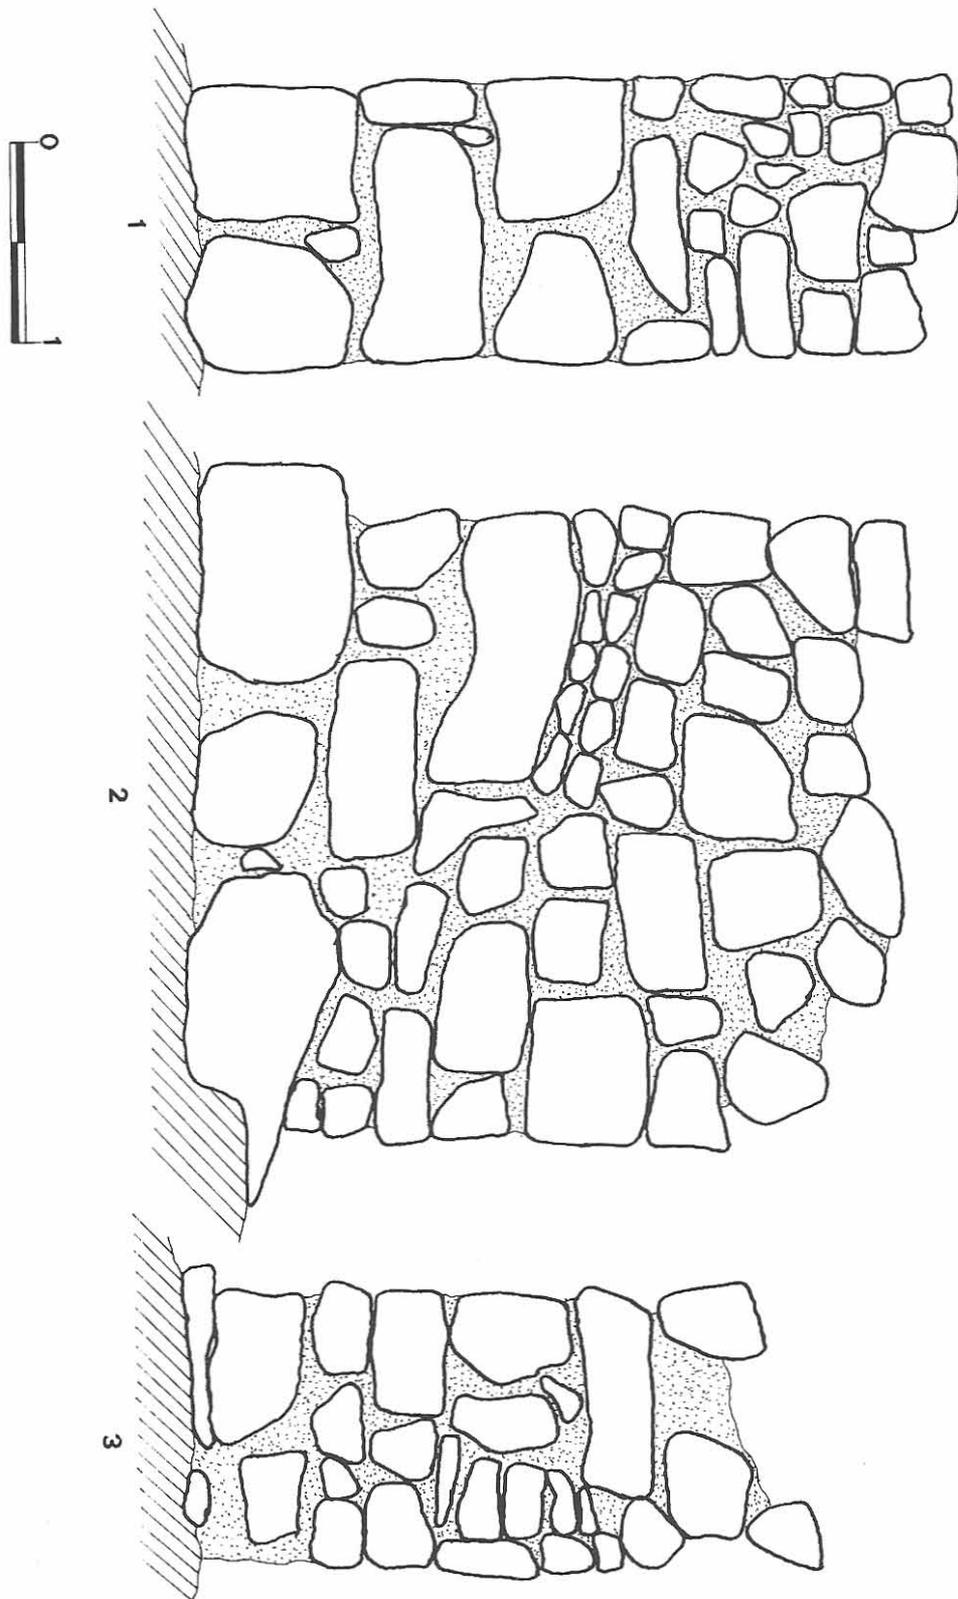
Torreón. nº 1.- alzado de la cara sur; nº 2.- alzado de la cara este; nº 3.- alzado de la cara norte.
